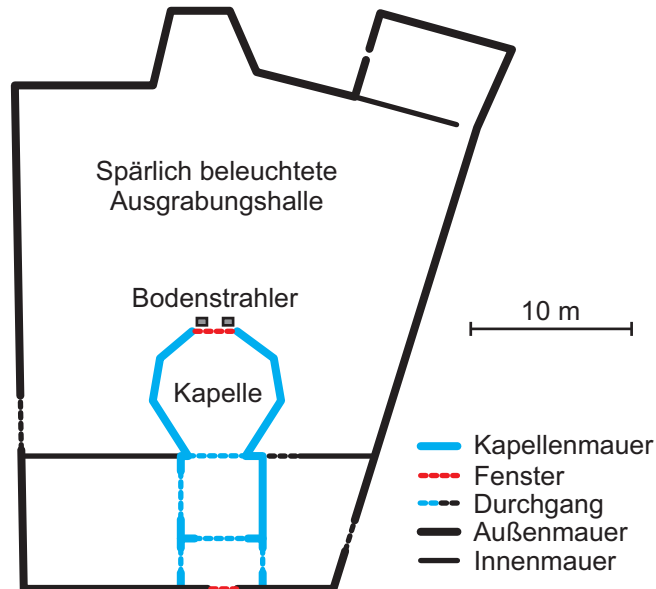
Skizzierter Grundriss der überbauten St. Kolumba Kapelle in Köln. Basierend auf [5]. Das Fenster der Kapelle hat keinen Zugang zu Tageslicht und wird durch auf dem Boden stehende Strahler beleuchtet.
